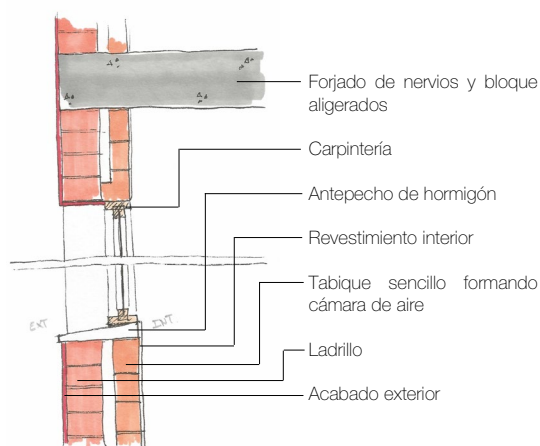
Detalle carpinterías de PVC (autoría propia).
